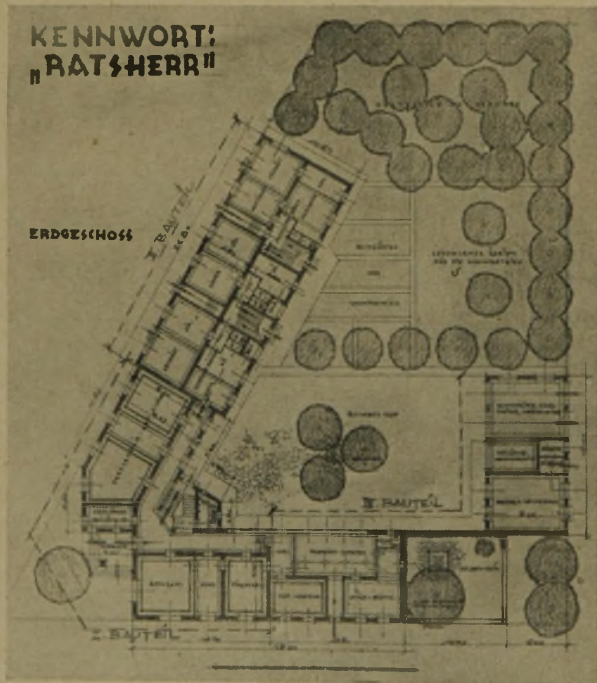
Grundriß vom Erdgeschoß zu Entwurf: „Ratscherr“. (1:750.)
